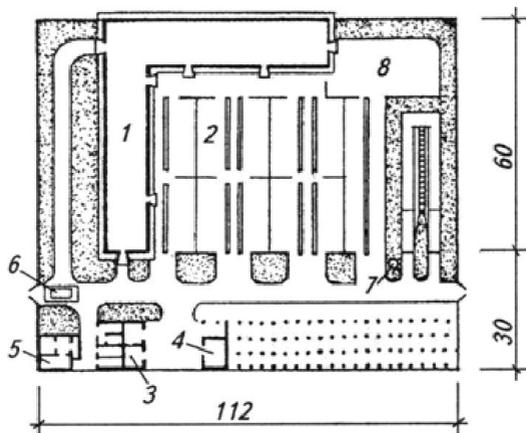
Генеральный план овцеводческой фермы на 600 маток:
